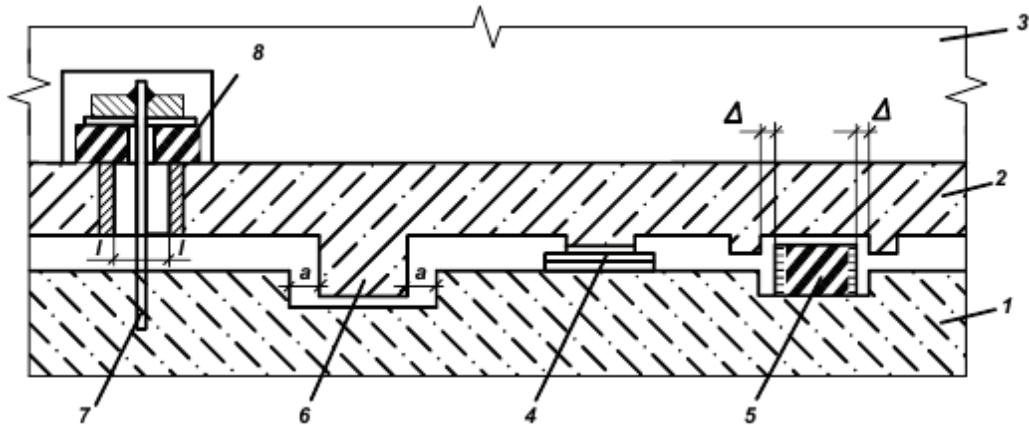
Схема элементов скользящего пояса для зданий с несущими стенами комплексной конструкции: 1 – верхняя обвязка фундаментов (стен подвала или технического этажа); 2 – ростверк (обвязка стен верхних этажей); 3 – надземные конструкции здания; 4 – скользящая опора; 5 – упругий ограничитель горизонтальных перемещений (демпфер); 6 – жесткий ограничитель горизонтальных перемещений (упор); 7 – ограничитель вертикальных перемещений (вертикальная связь); 8 – вертикальный амортизатор
